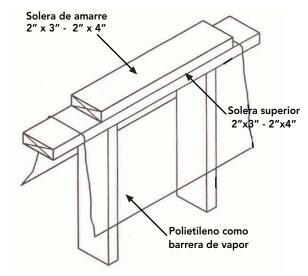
30: Sección de polietileno colocado sobre el tabique interior entre la solera de amarre y la solera superior, para el posterior traslape con la barrera de vapor colocada en el cielo.
